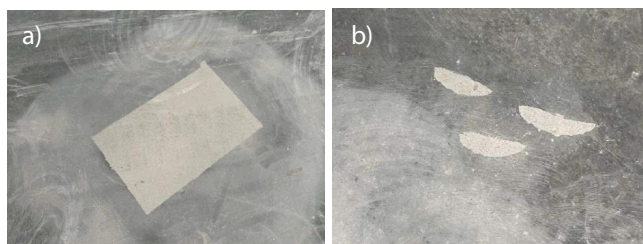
Zdegradowana betonowa posadzka przemysłowa (przykład 1) podczas naprawy: inwentaryzacja uszkodzeń, usuwanie kotw montażowych
